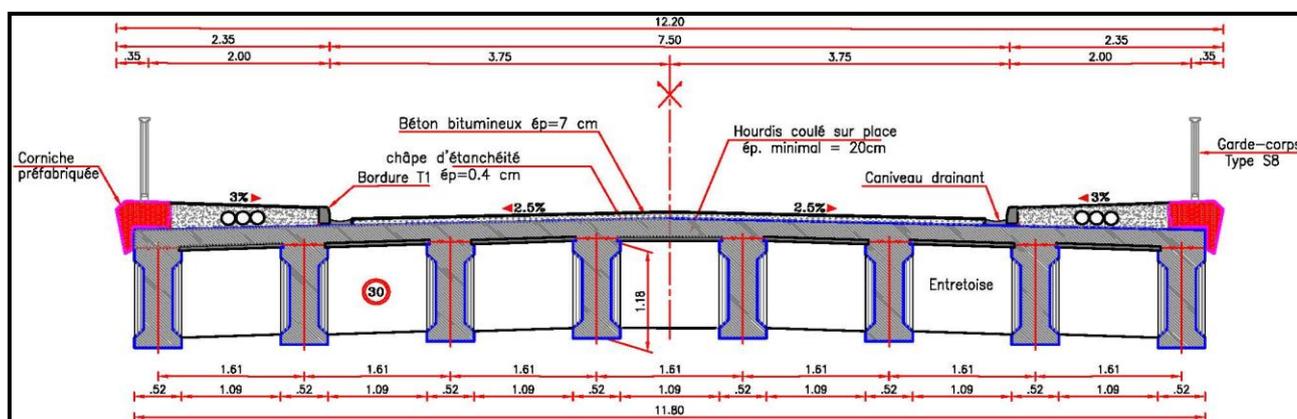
Coupe transversale du tablier du pont sur la lagune de Ouidah (pont à poutres en béton armé)
